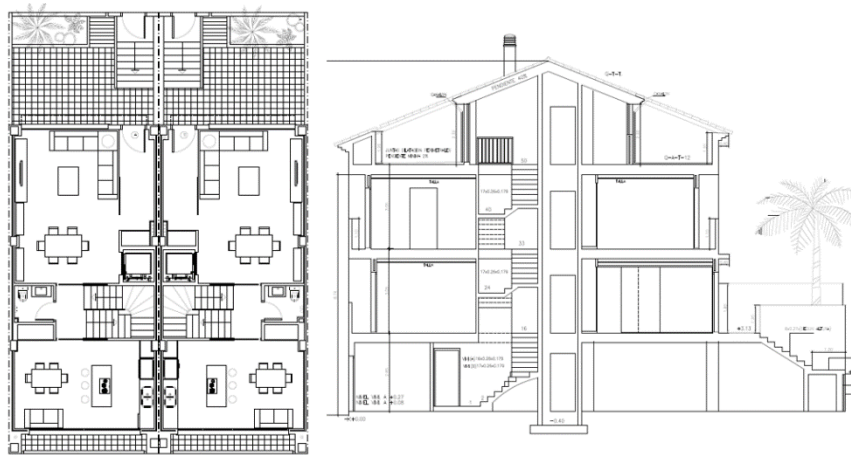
PB y Sección de proyecto. 2014. Anexo I
